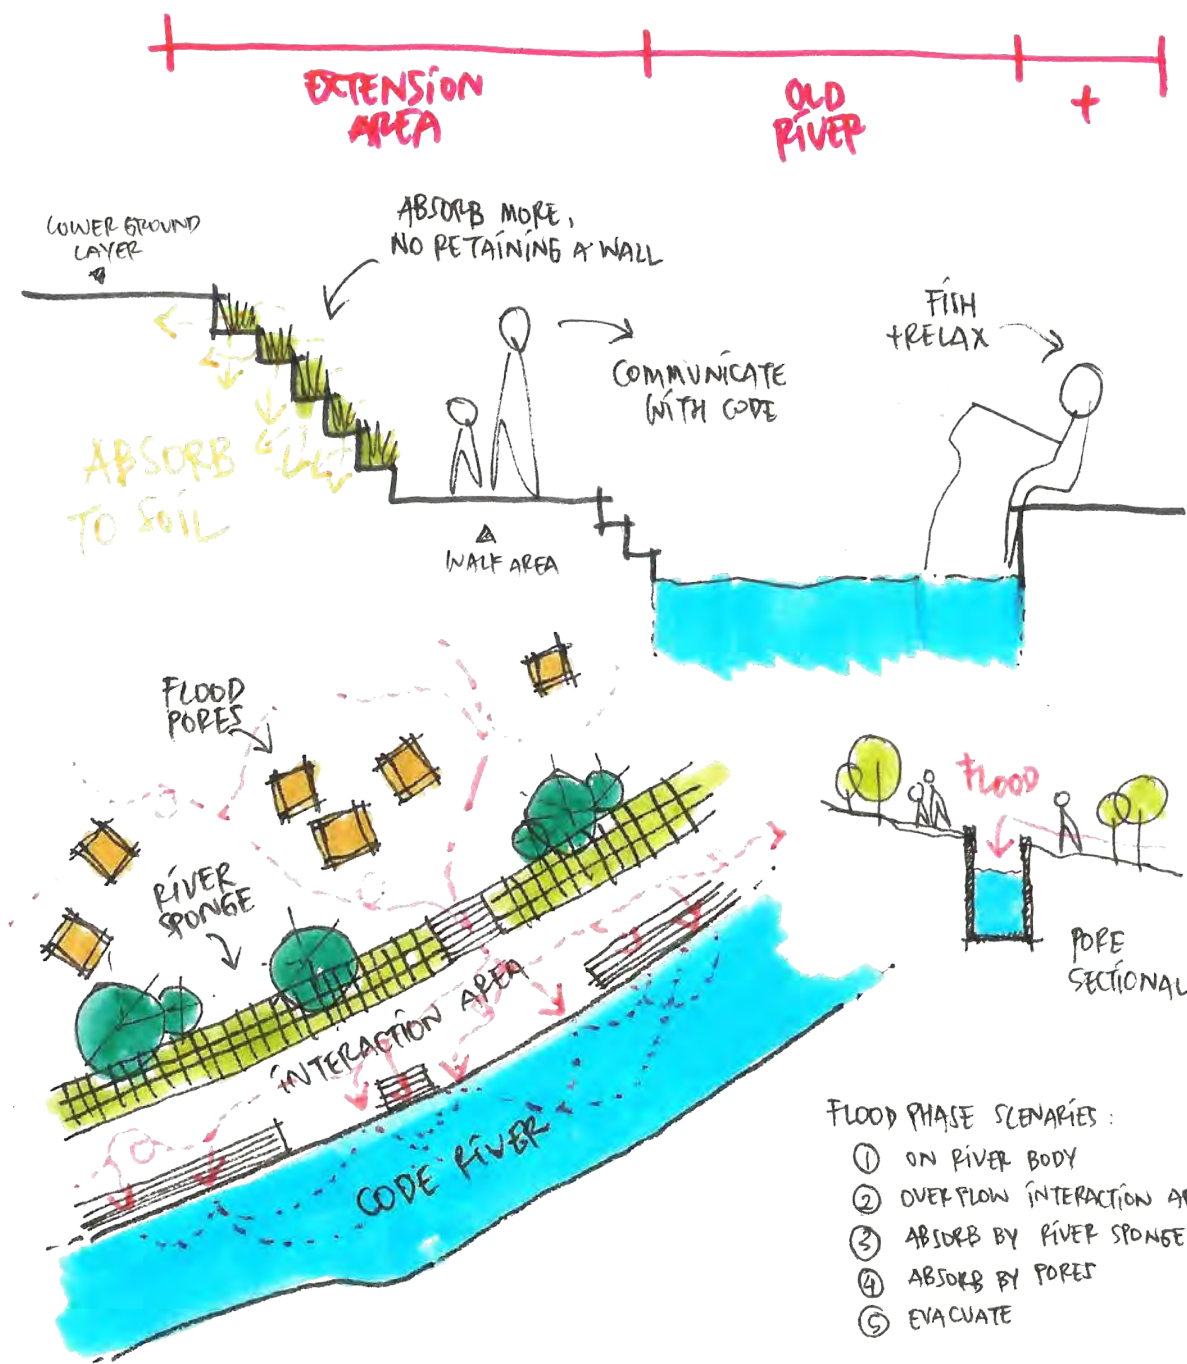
Contoh Fitur Pengolahan Ulang Bangunan pada Lapisan Lama
